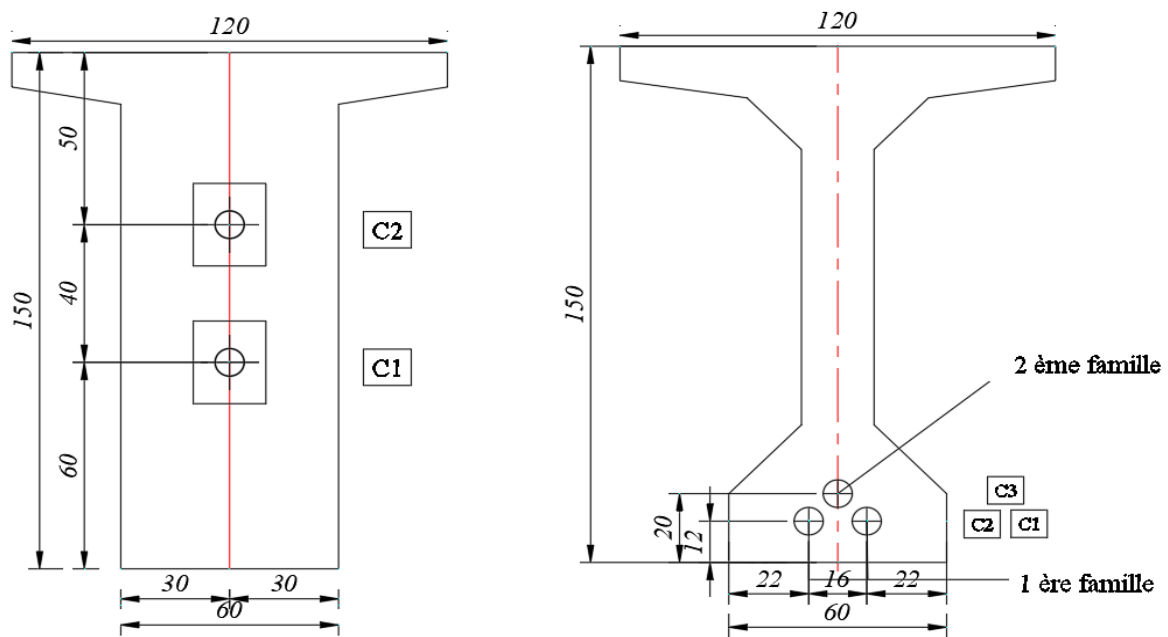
Disposition des câbles à l'about// Disposition des câbles à mi-travée
